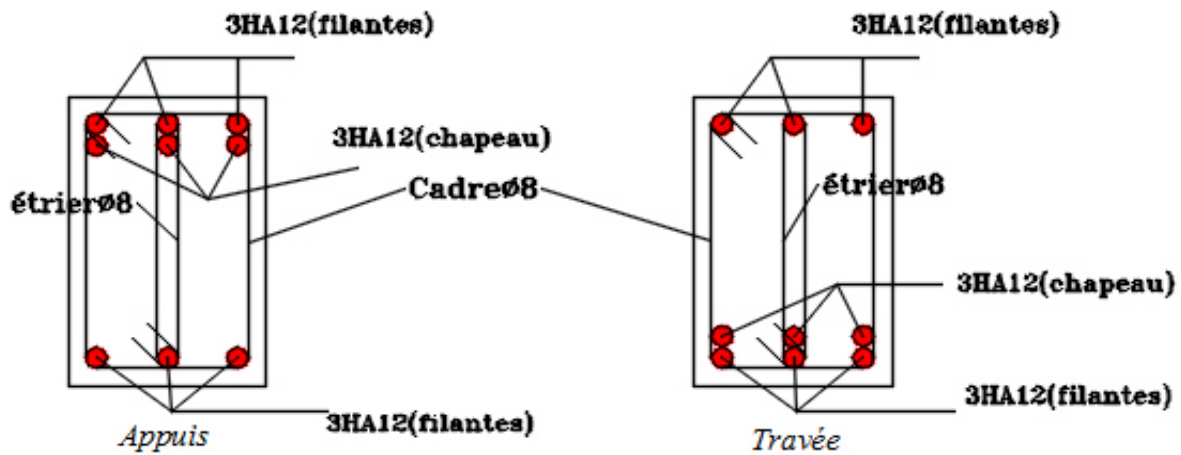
schéma de ferrailage des poutres secondaires de la terrasse
